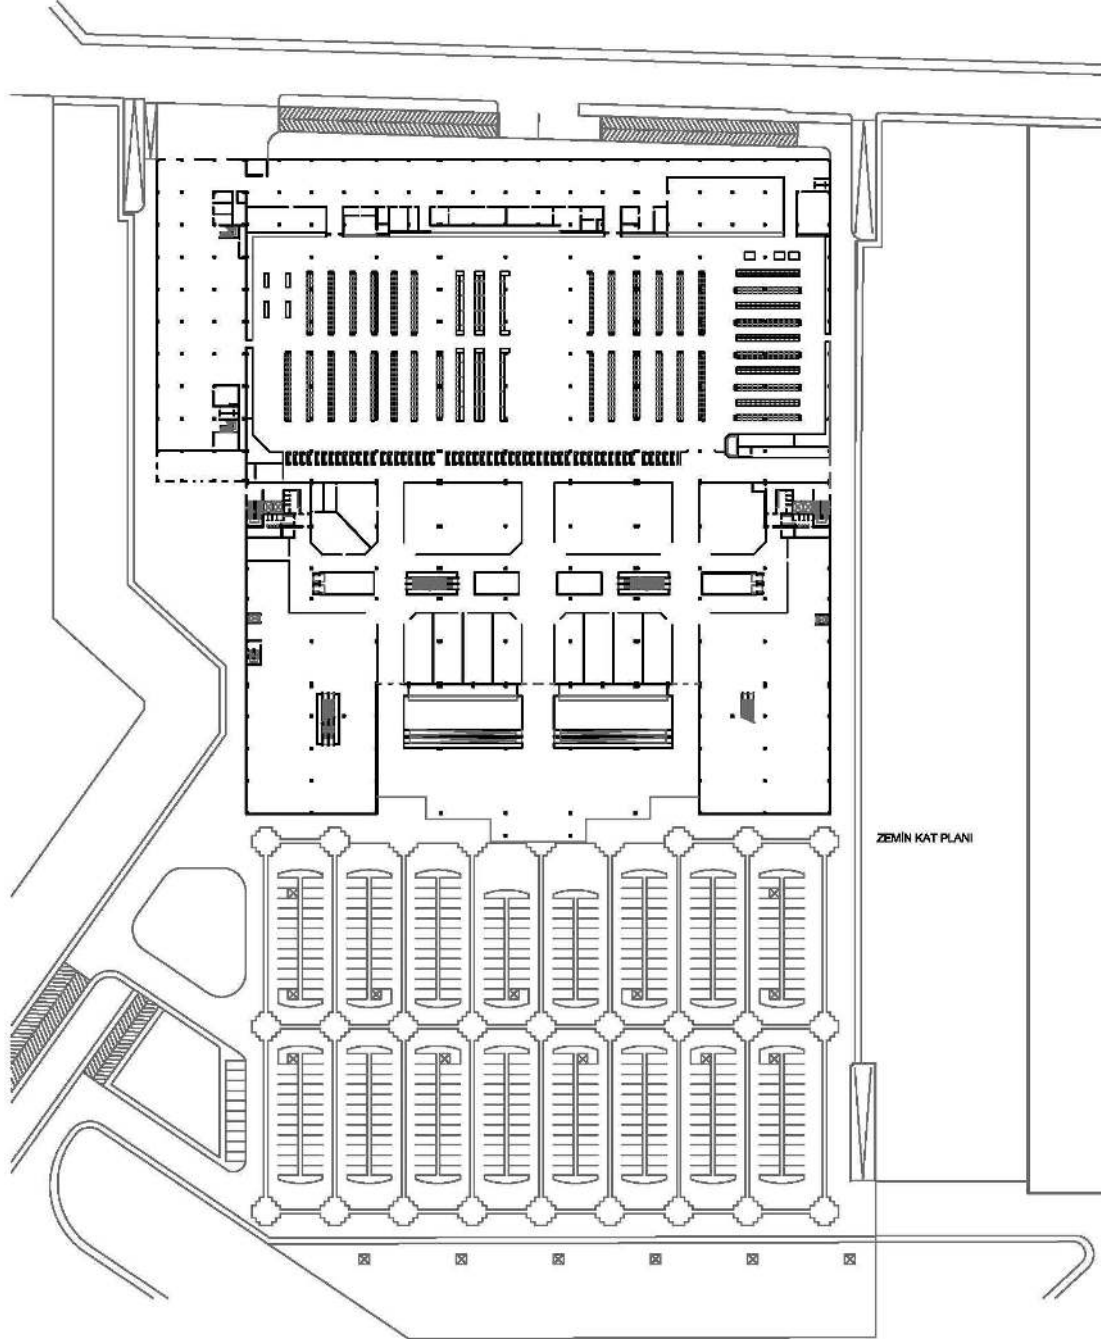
Migros-ANKAMALL Alışveriş Merkezi vaziyet planı
